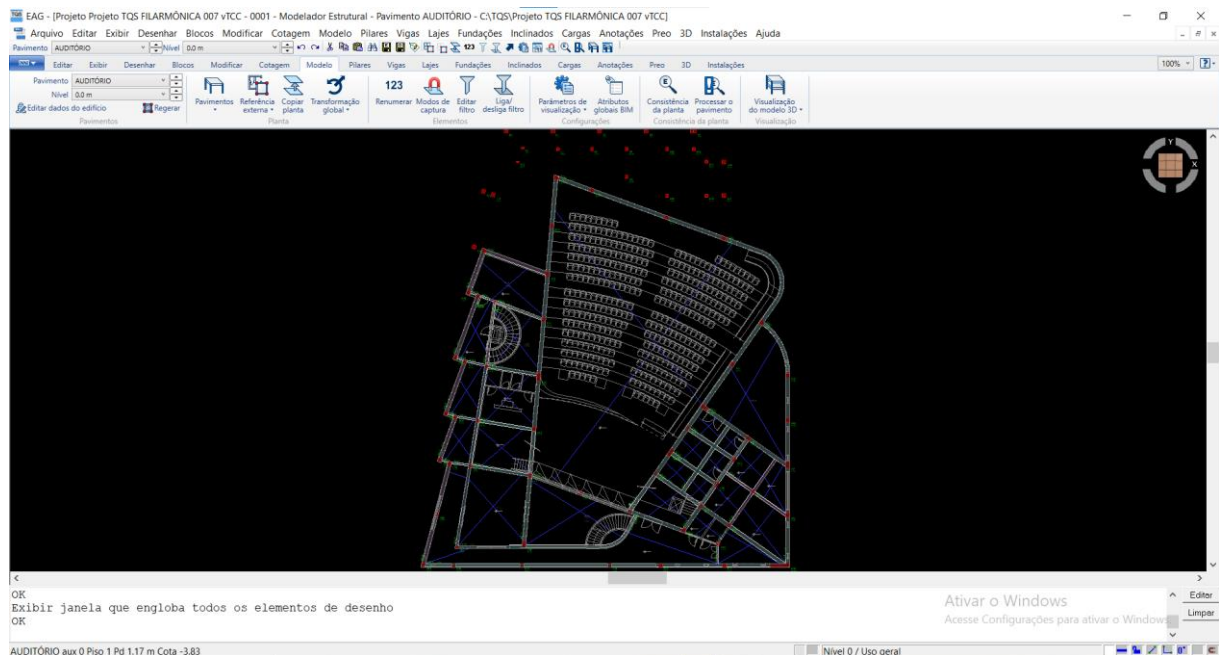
75 - Pavimento Auditório com a planta copiada.
